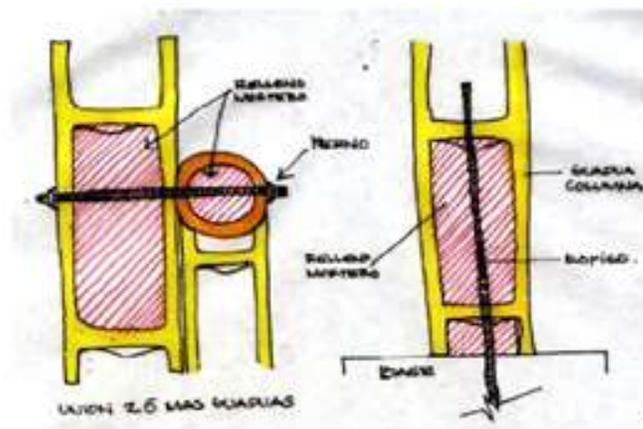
Diseño del anclaje de la caña guadua hacia el hormigón.
